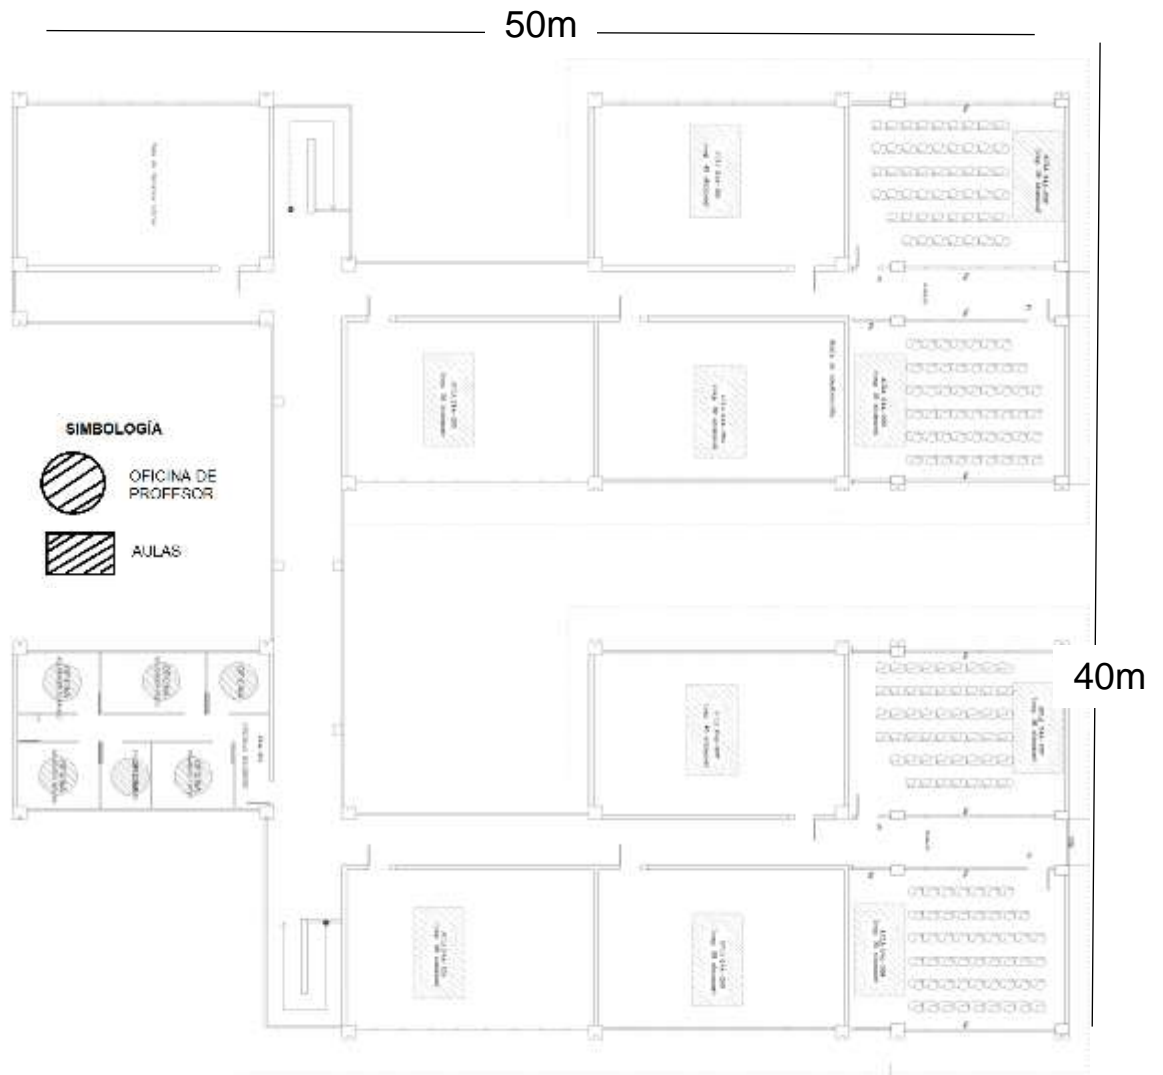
Plano Aéreo del Bloque 24A y B – planta alta[9]
